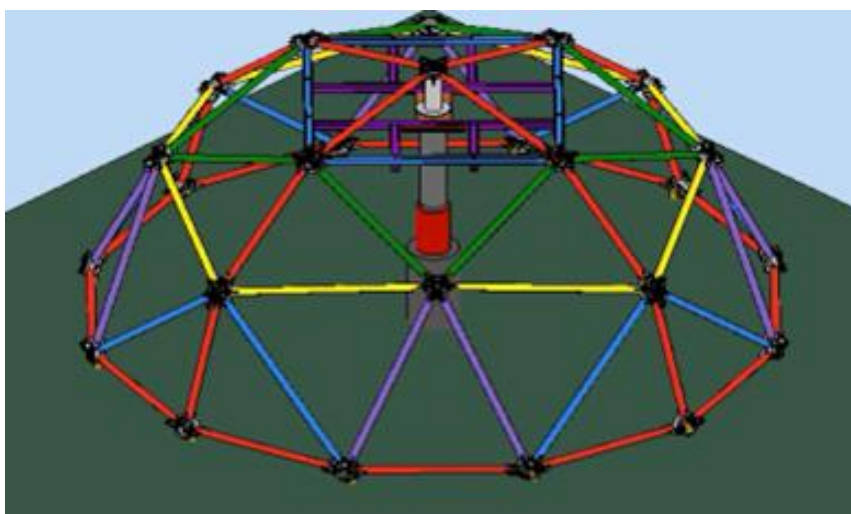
Конструкция установки для статических испытаний грунта сваями
